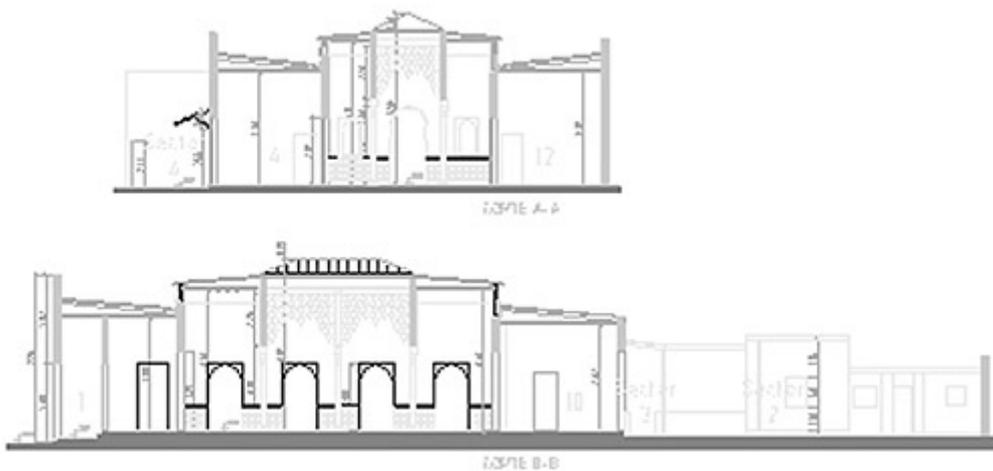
Plano de corte transversal y longitudinal, 2007
